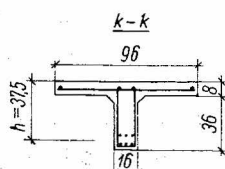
Poutres en forme de double T dans les essais de LEONHARDT et WALTHER [53] (DAfSt, cahier 156)
